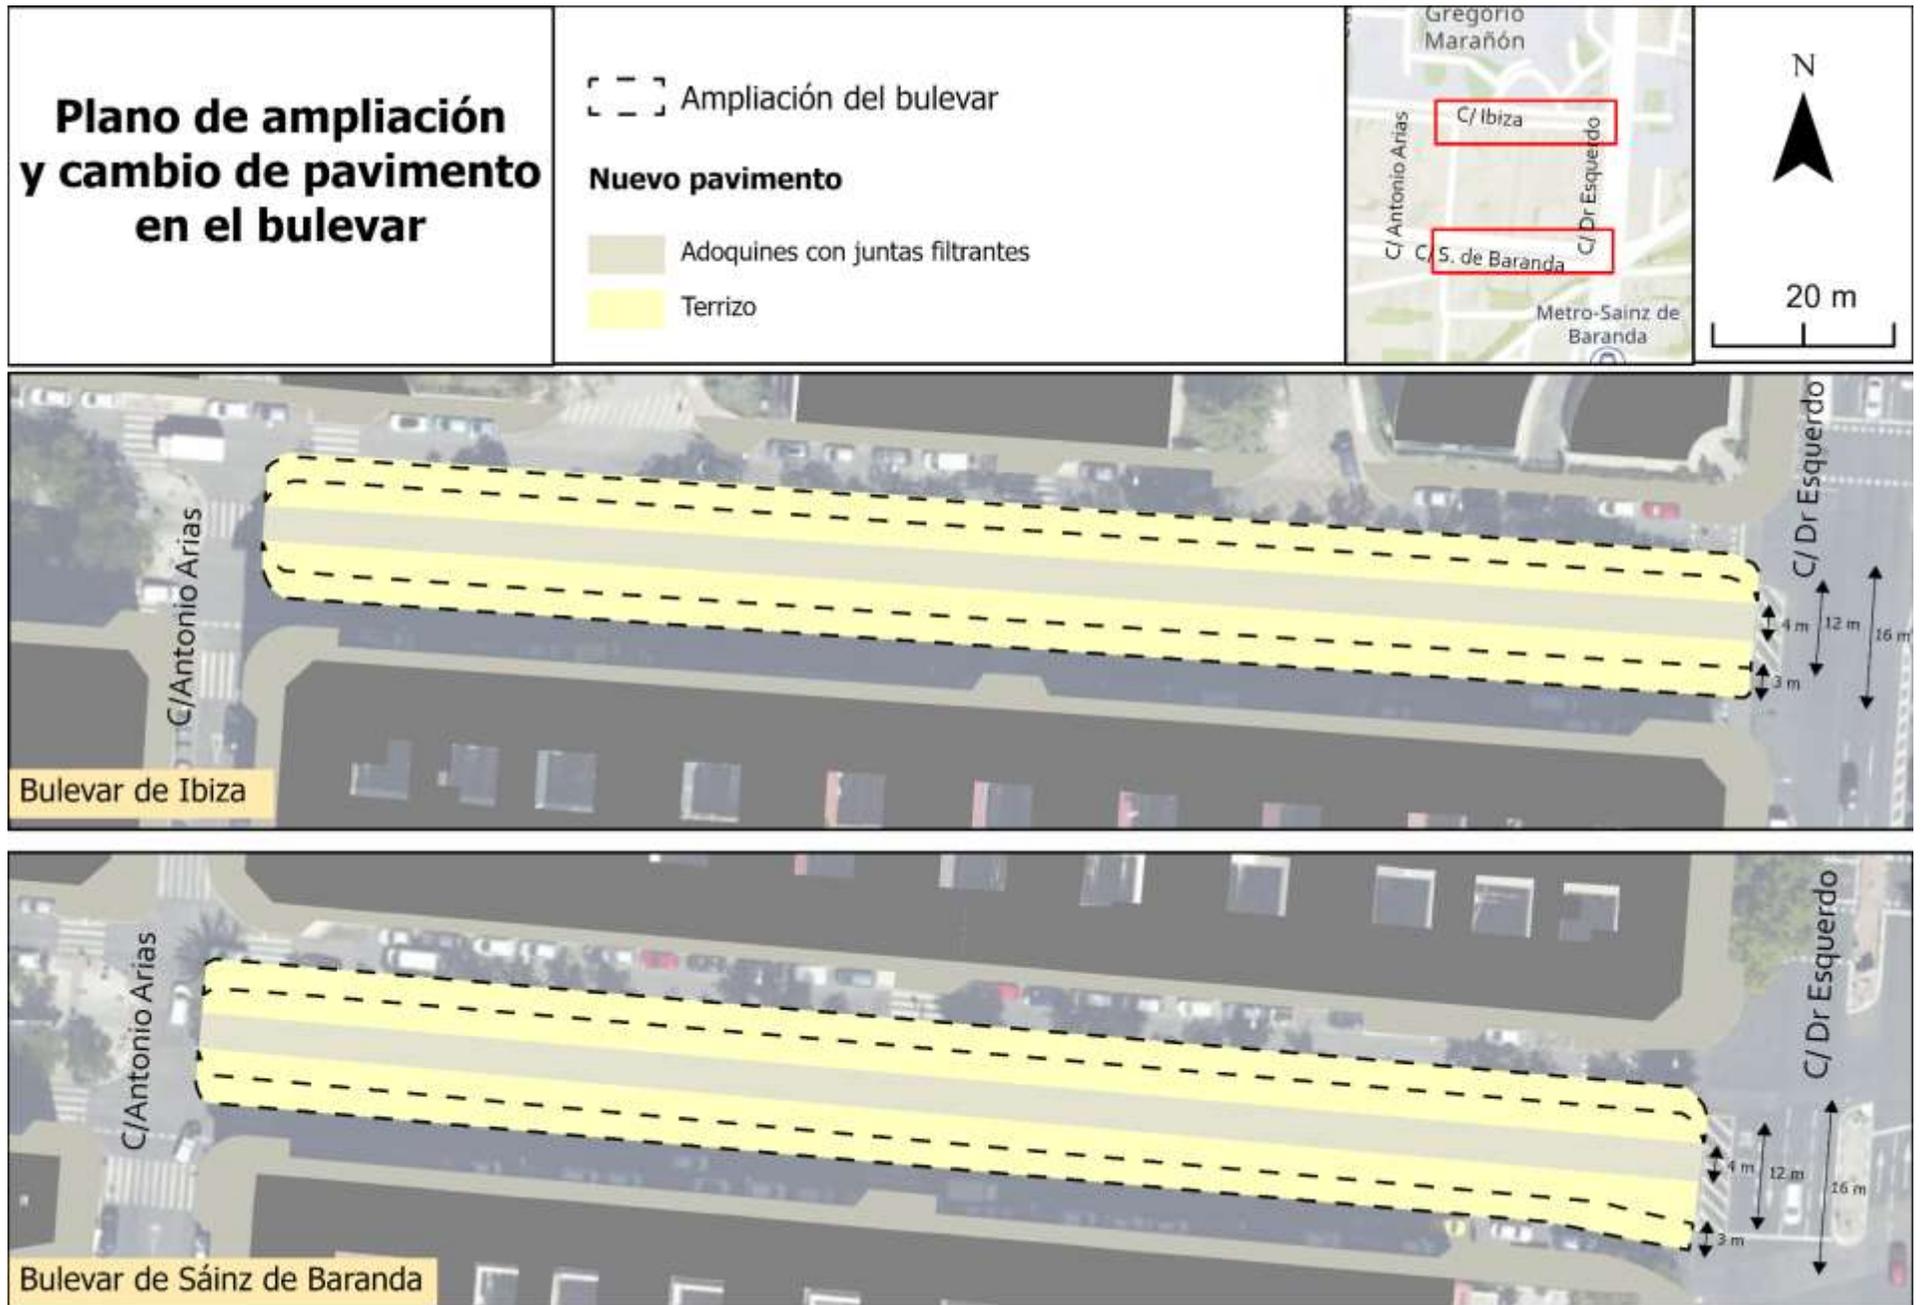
Plano de la ampliación y cambio en el pavimento de los tramos de bulevar. Fuente: Elaboración propia
